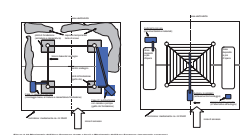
Planimetrica dell'Area Sostegno tipo (scavo di fondazione)
